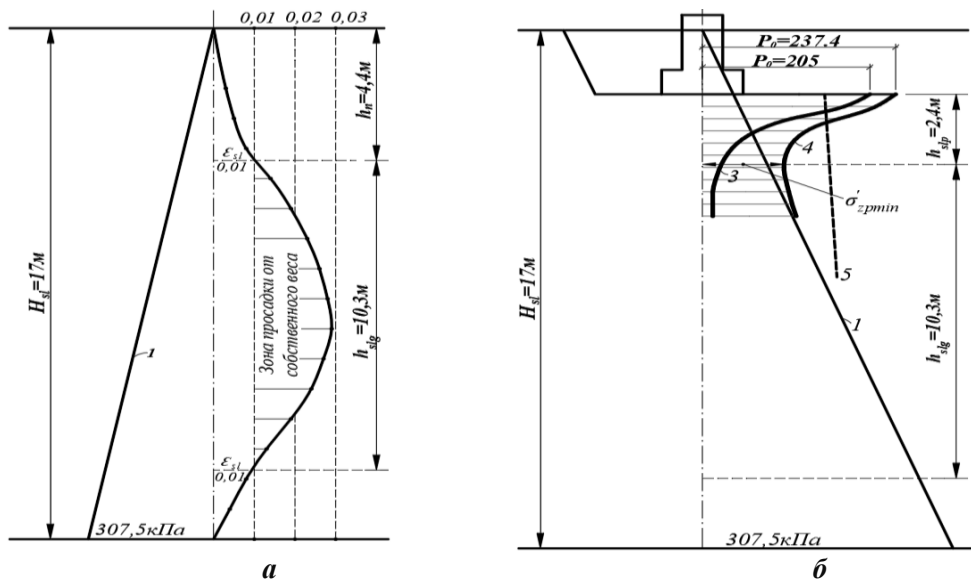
Схемы к расчету просадки грунта от собственного веса (а) и внешней нагрузки (б)
